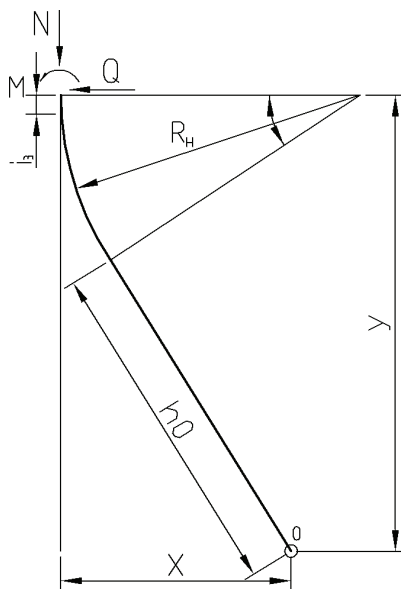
Схема работы стойки металлической арочной трехзвенной крепи.
